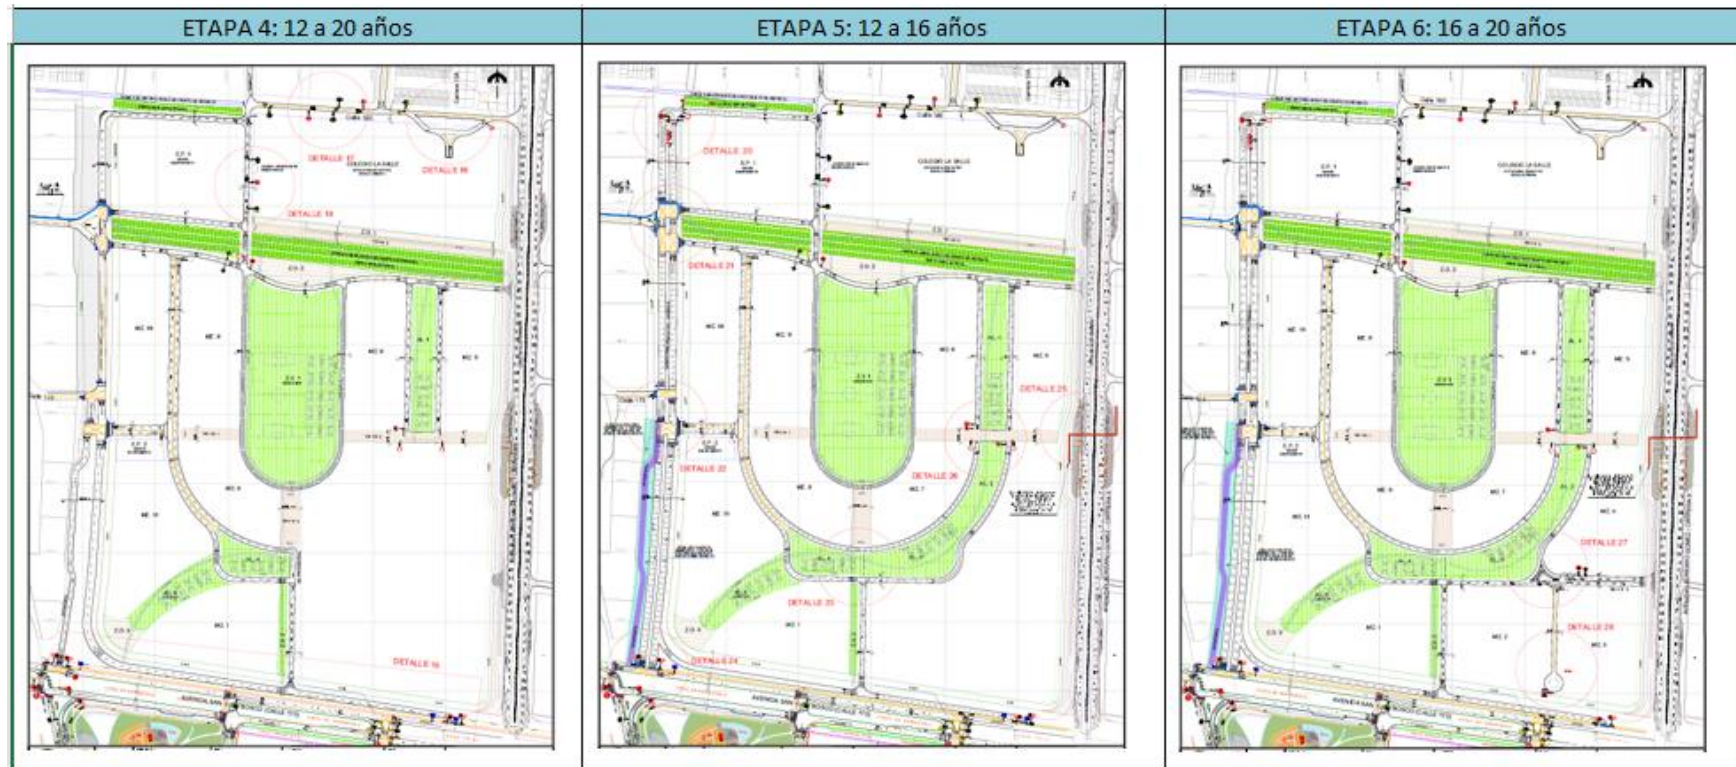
Detalles de las obras viales correspondientes a las etapas 4, 5 y 6 de desarrollo del plan parcial
